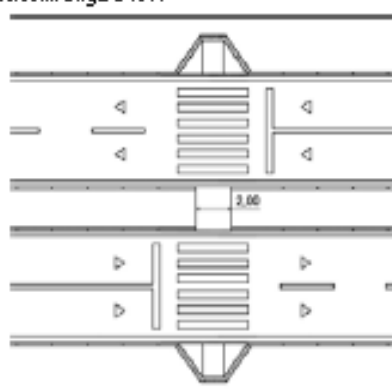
Canteiro divisor de pistas - Exemplo 2
